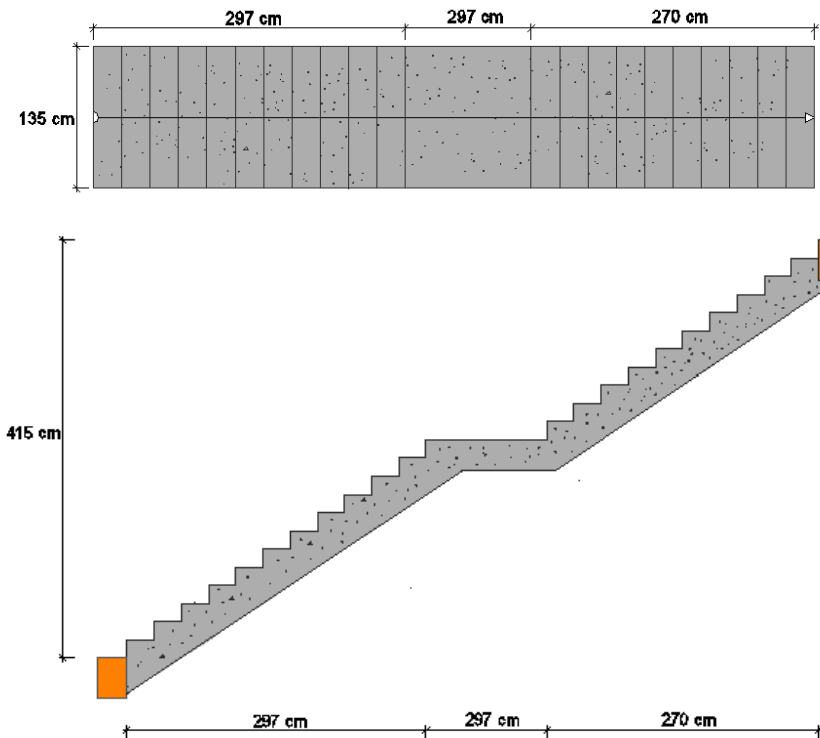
Geometría de la Escalera N°1; Elaboración Propia
